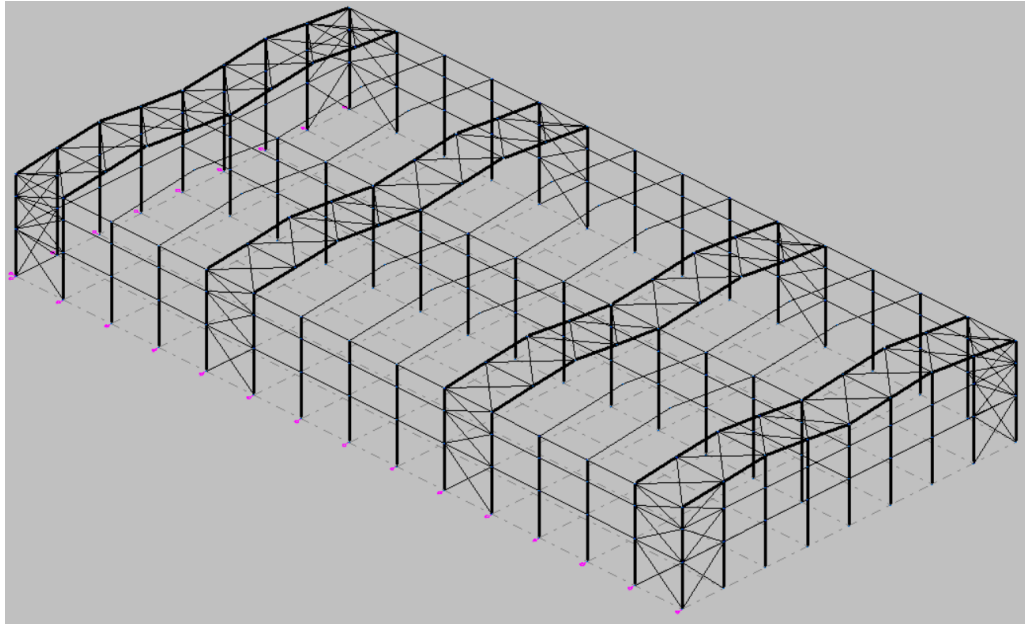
Vista 3D de la nave. Fuente: CYPE
